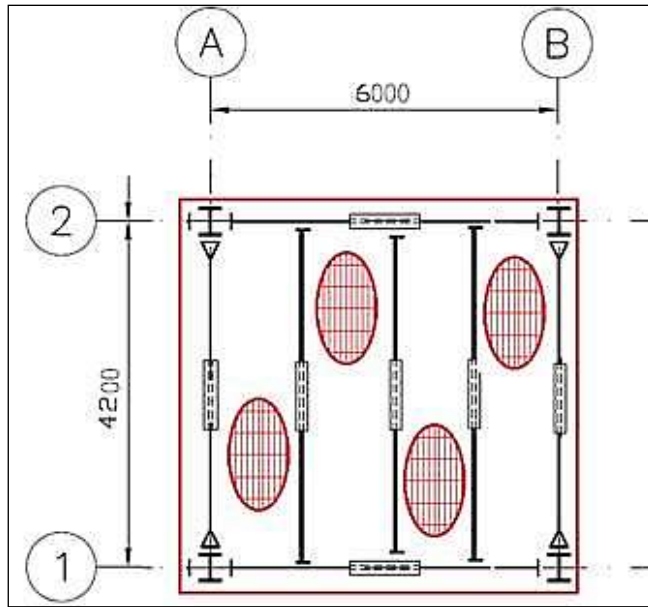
Detalle de Plataforma - Vista de Planta PSLRG
